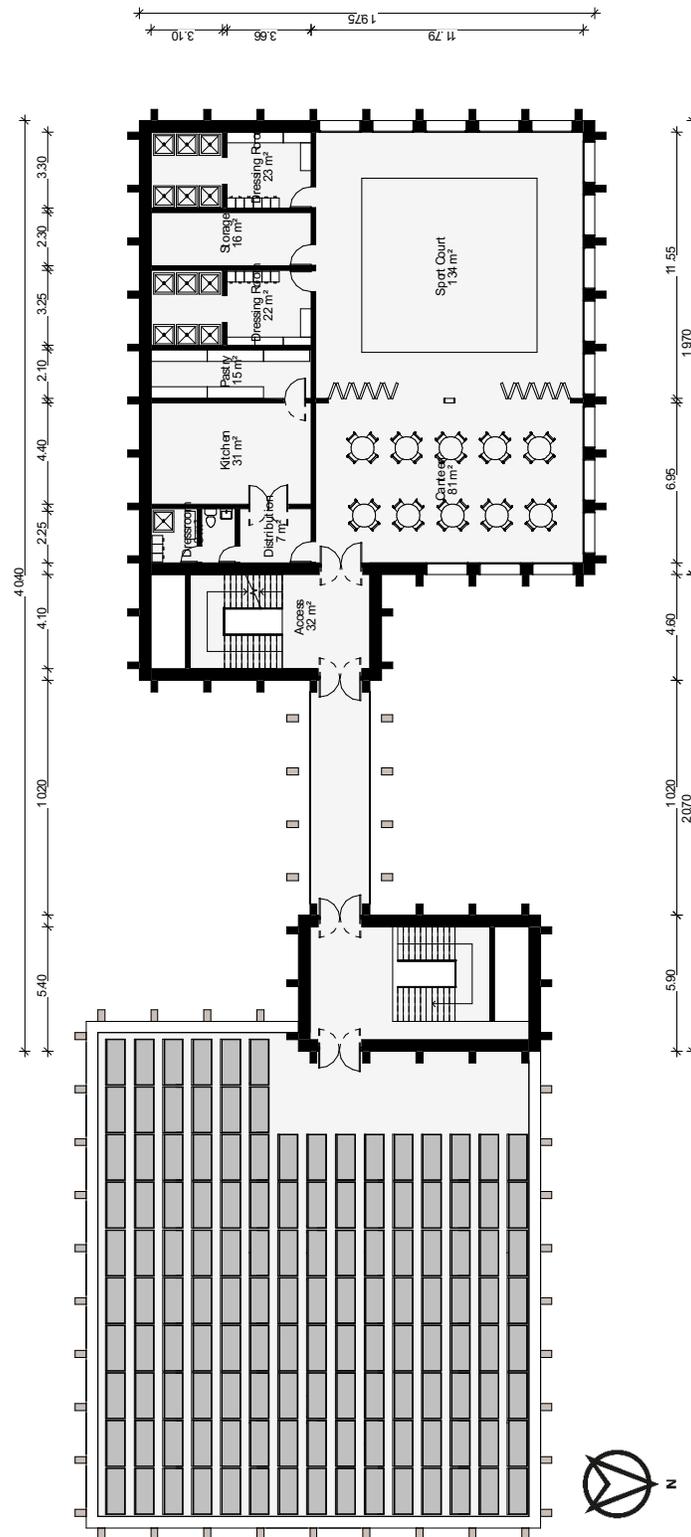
Planta segundo nivel prototipo (Fuente: elaboración propia)
